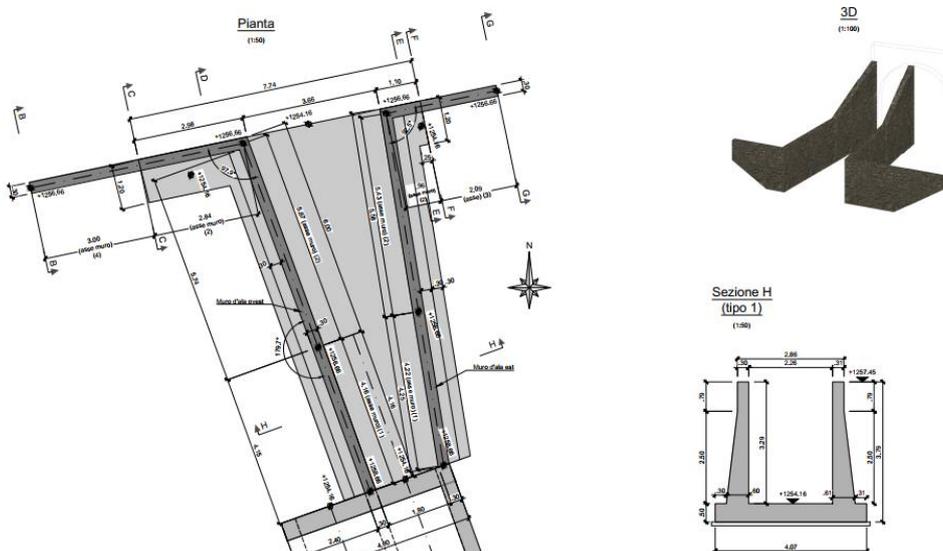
muri d'ala all'uscita dello scarico di fondo: planimetria, sezione trasversale e modello 3D
